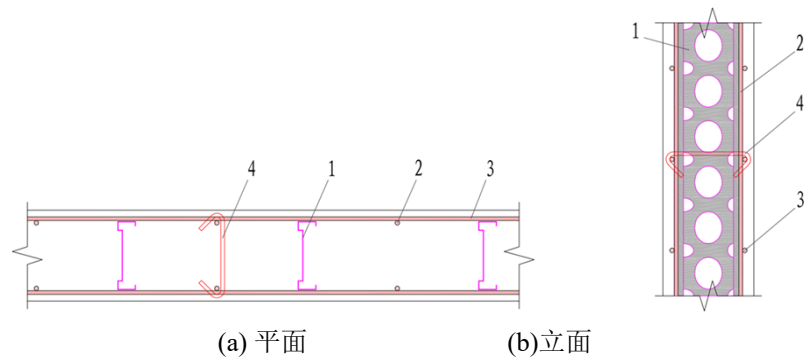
成型钢骨架混凝土剪力墙构造（钢骨架水平钢筋在外侧）
